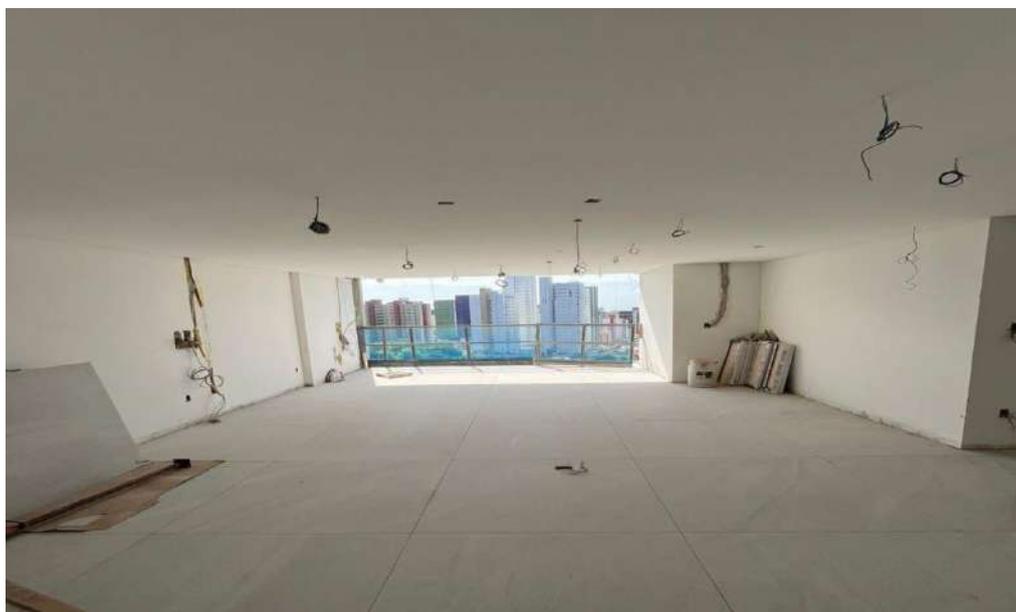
Reforma do apartamento tipo 2 – Disposição sem vigas e pilares internos.
